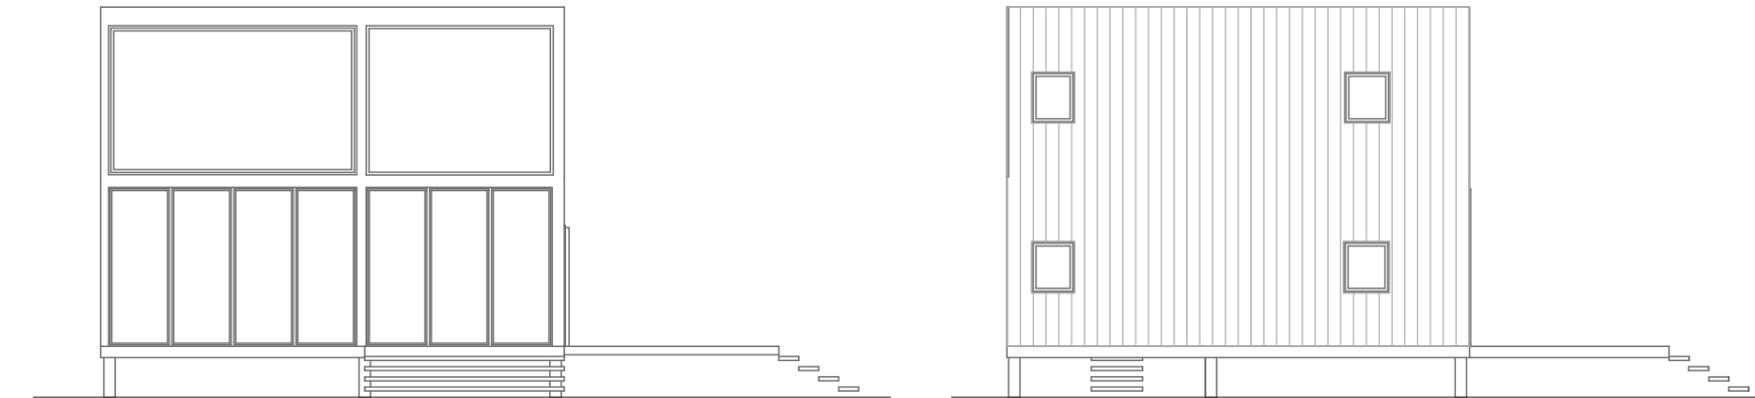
Perspectiva exterior Box House/Neeson Murcutt Architects
